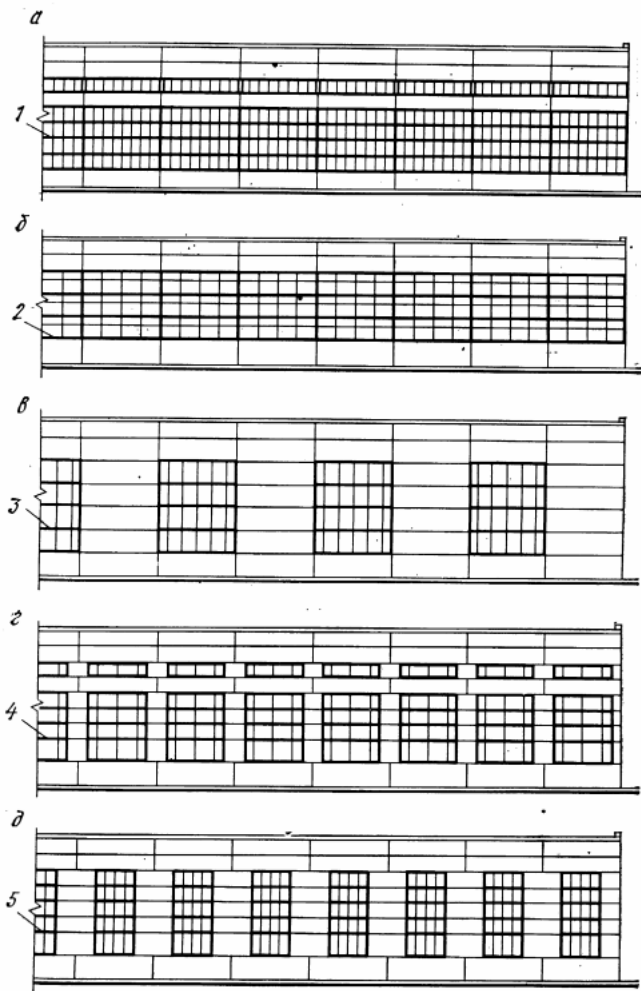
Варіанти розрізки стін одноповерхових будівель:
